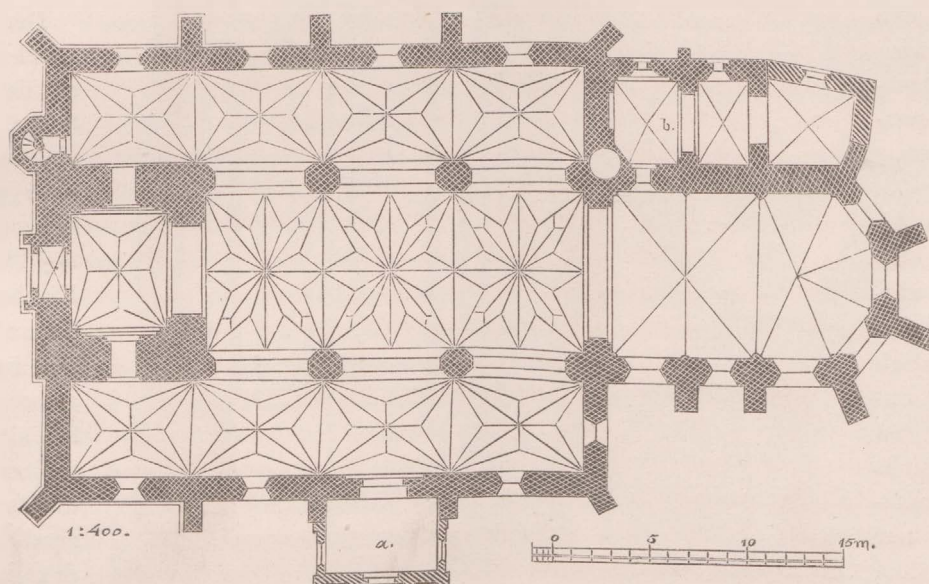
Graudenz. Grundriss der kath. Pfarrkirche.
